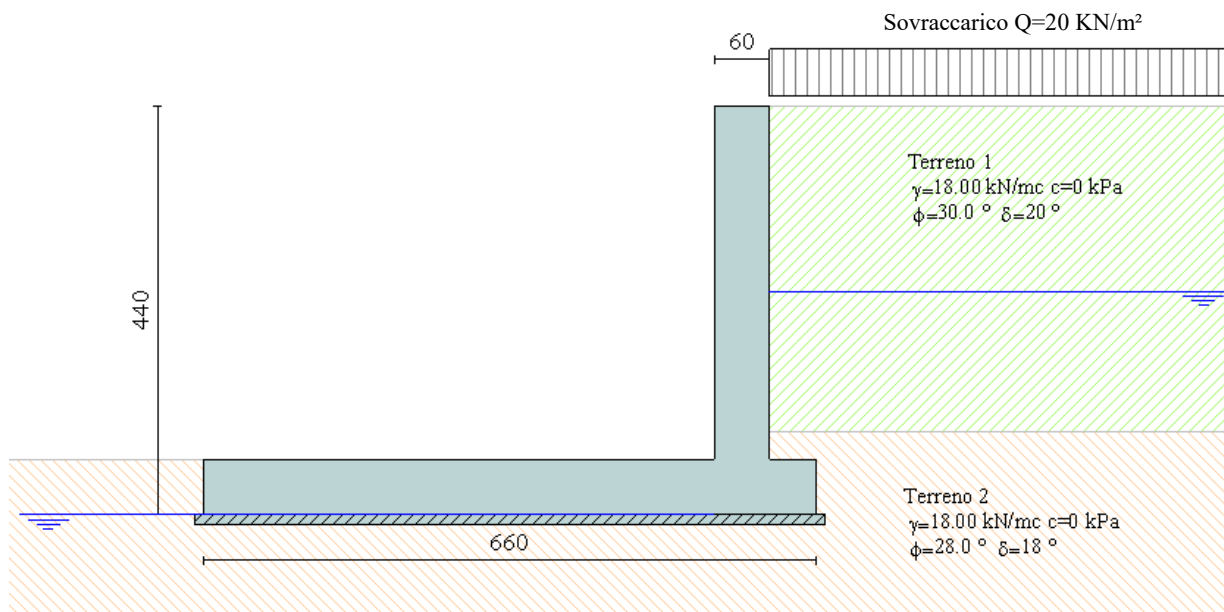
Modello geotecnico e strutturale, sezione trasversale dell'opera di derivazione
